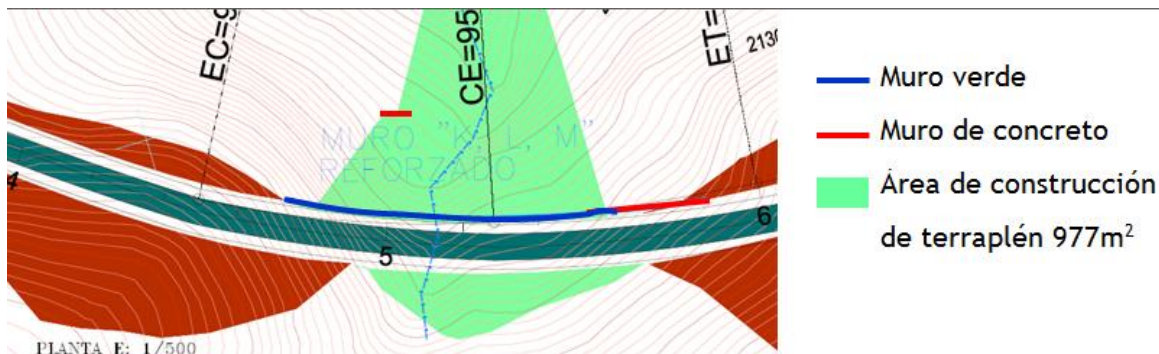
Planta Comparativa de Solución de diseño de ingeniería con muro verde vs. Muro de Concreto armado.
